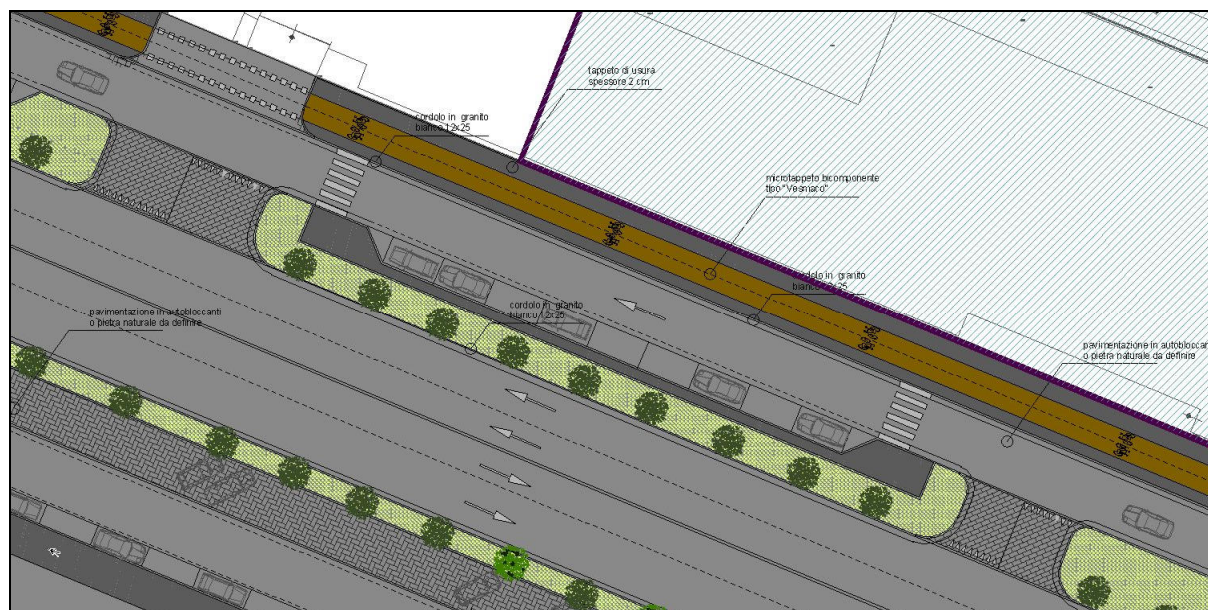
Planimetria di progetto asse corso Bramante – dettaglio dell'asse
